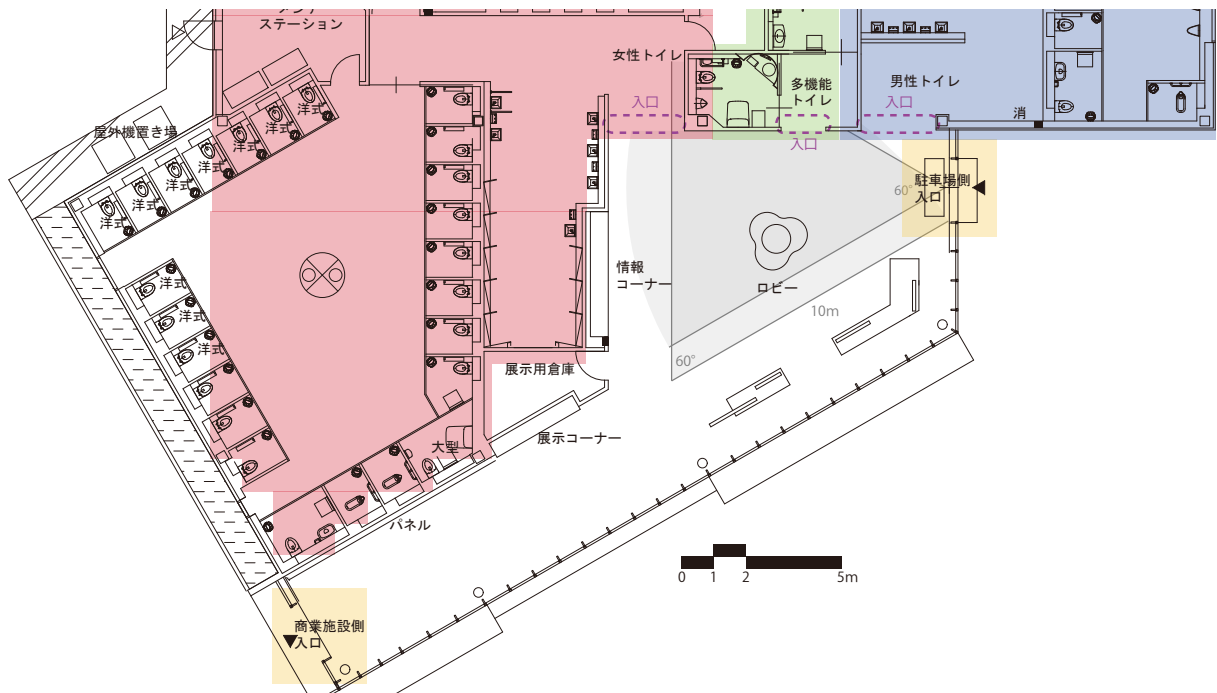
藤枝PA（上り）平面図、エリア設定状況及びサイン設置状況
